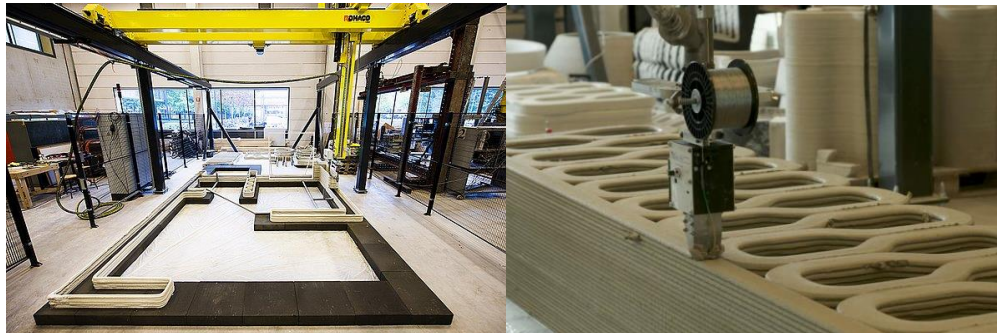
Impresora de TU/e, 3DCP. Fuente: <https://3dprintedhouse.nl/en/>
